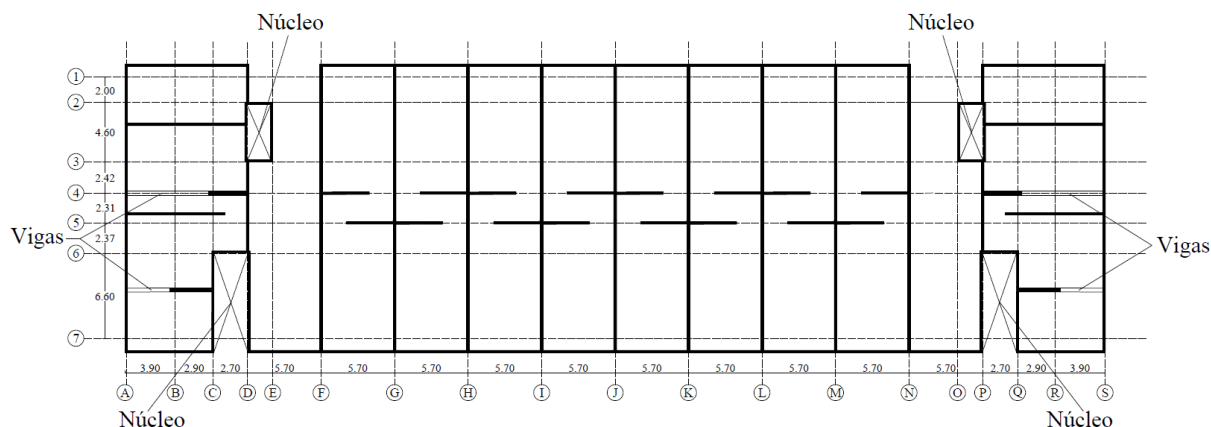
Configuração estrutural do 2º ao 7º piso do edifício em CLT (paredes a cheio)
